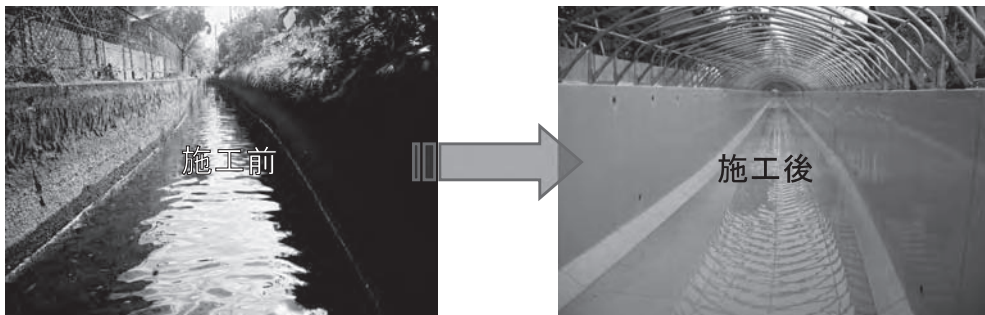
施工前・施工後写真（上川原幹線水路（その2）工事）
